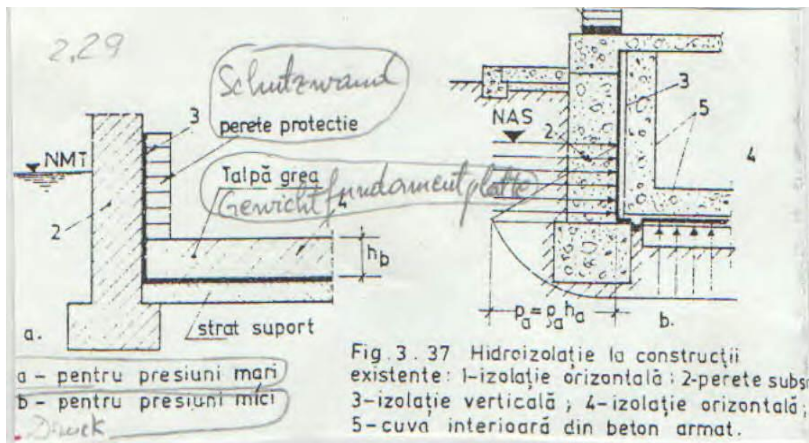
37 Hidroizolație la construcții existente: 1-izolație orizontală; 2-perete subs; 3-izolație verticală; 4-izolație orizontală; 5-cuvă interioară din beton armat.
